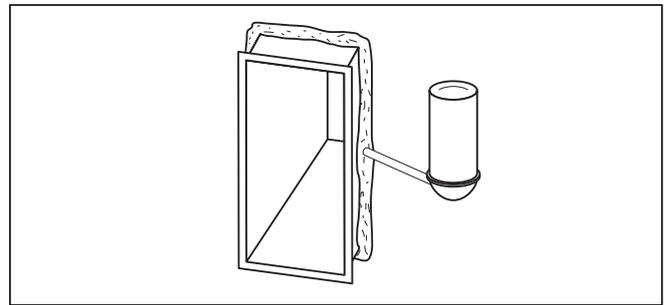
Wandöffnung mit Montageschaum abdichten
